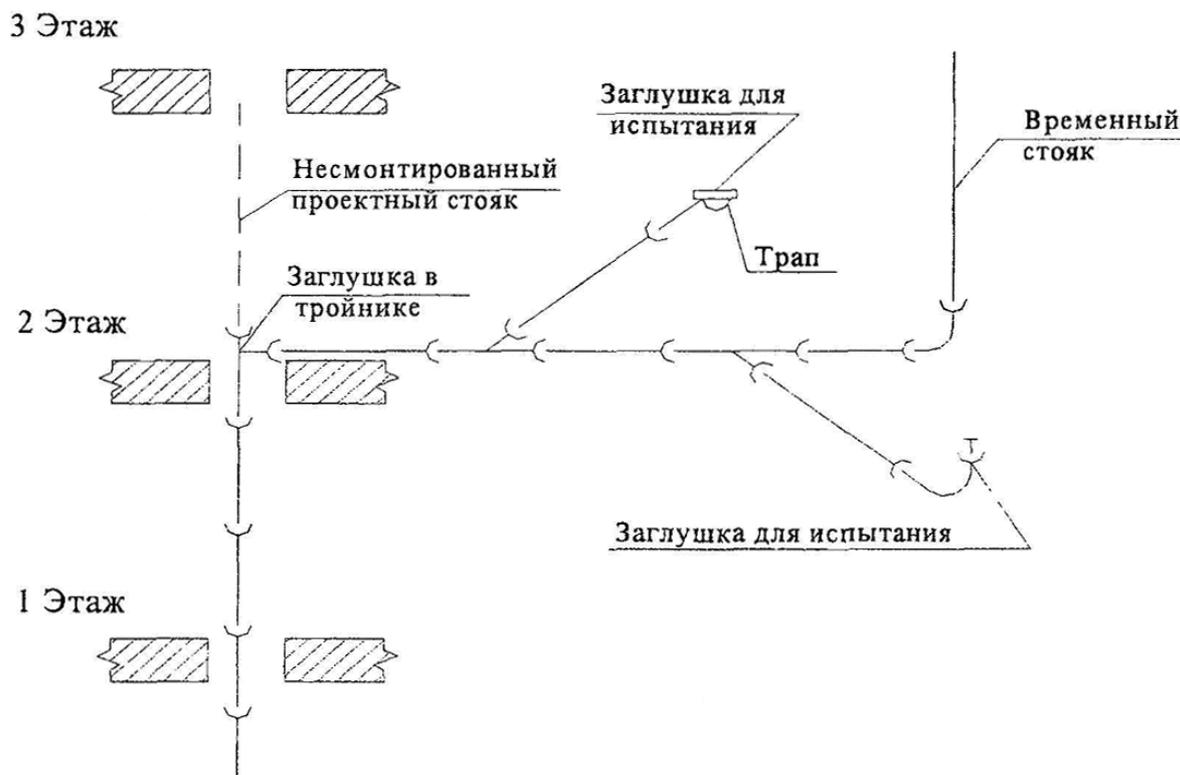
Схема гидростатического испытания отводных трубопроводов, проложенных в конструкциях междуэтажных перекрытий.
